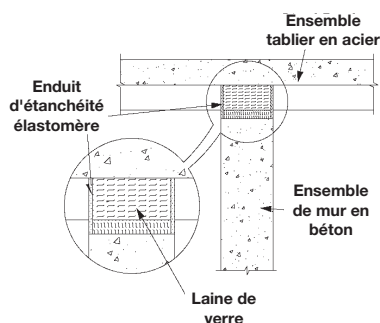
JOINT DE TÊTE-DE-MUR – MUR PLAQUES DE PLACOPLATRE À BÉTON DU TABLIER EN ACIER
